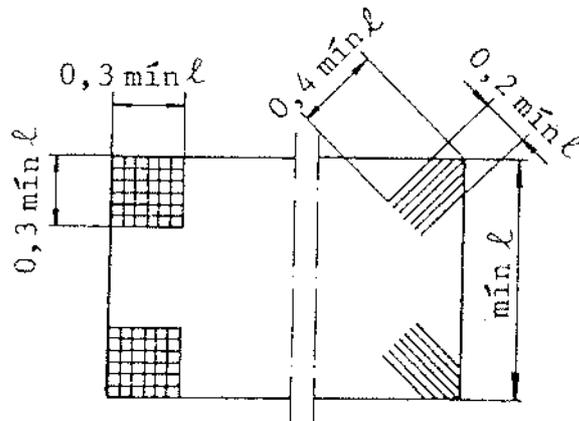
Armadura superior de esquina: ortogonal y oblicua.
